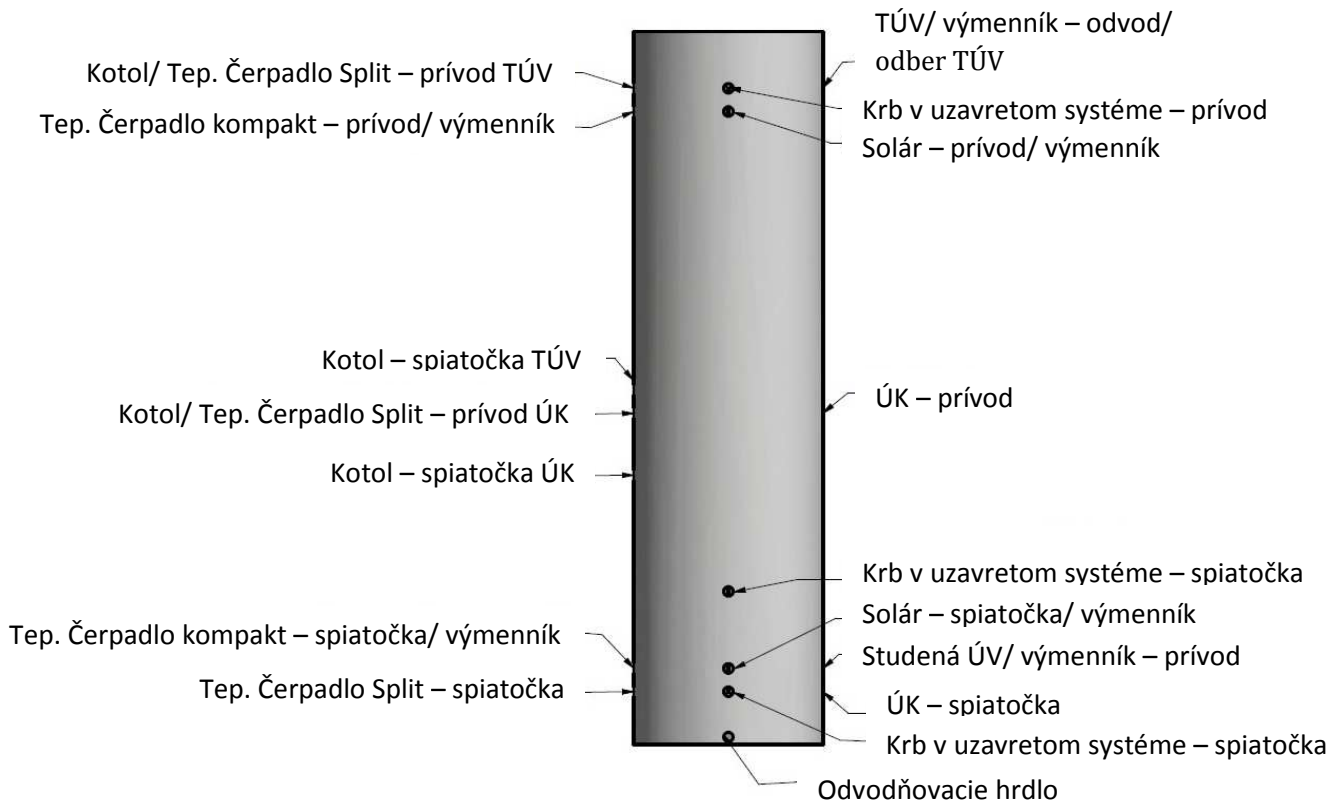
Popis hrdiel zásobníkov COMBO II PC
